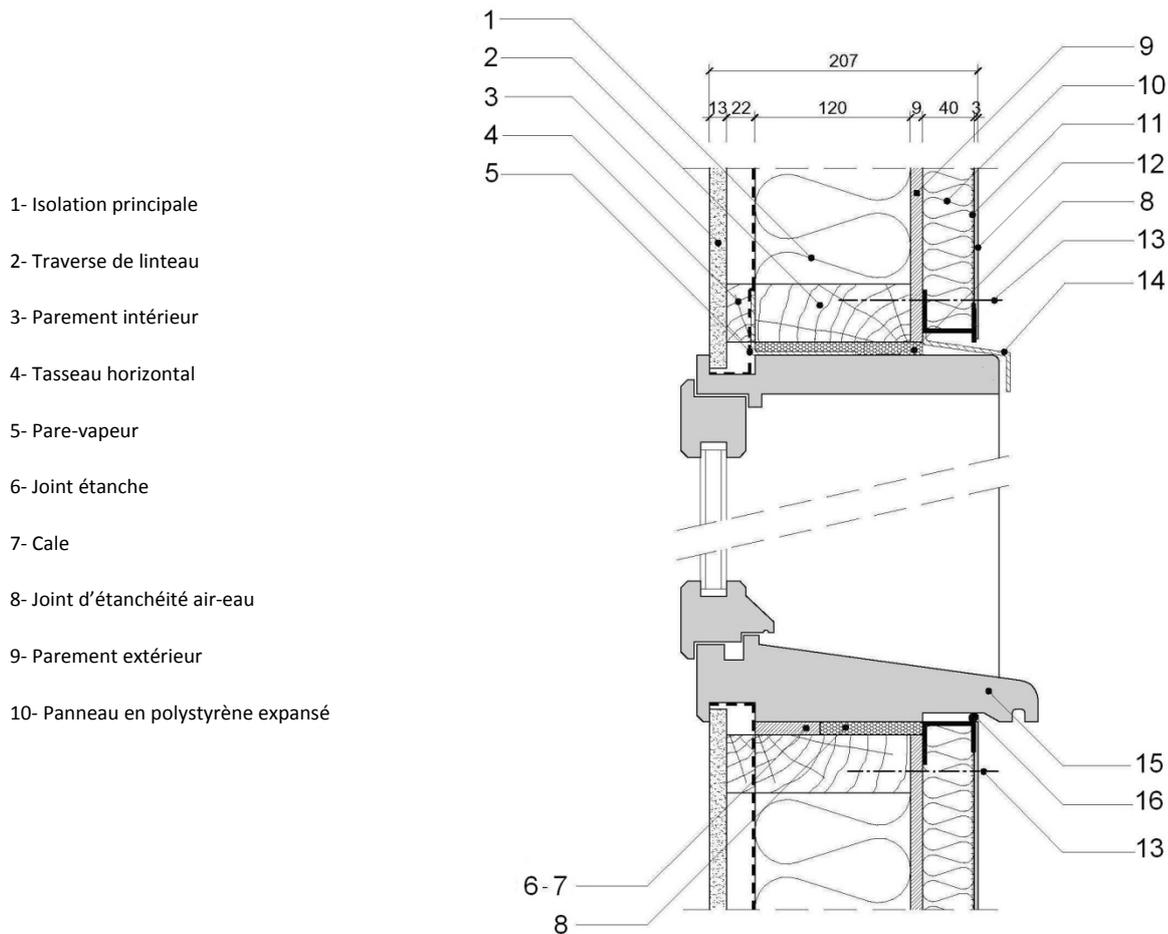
Fixations complémentaires au niveau des baies (coupe verticale)
